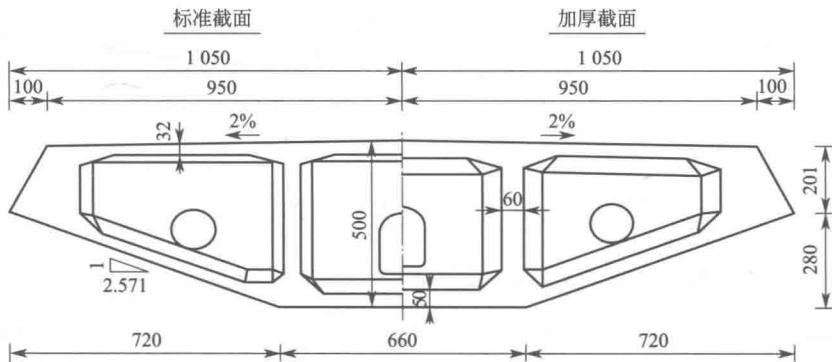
混凝土加劲梁截面图(单位:cm)
